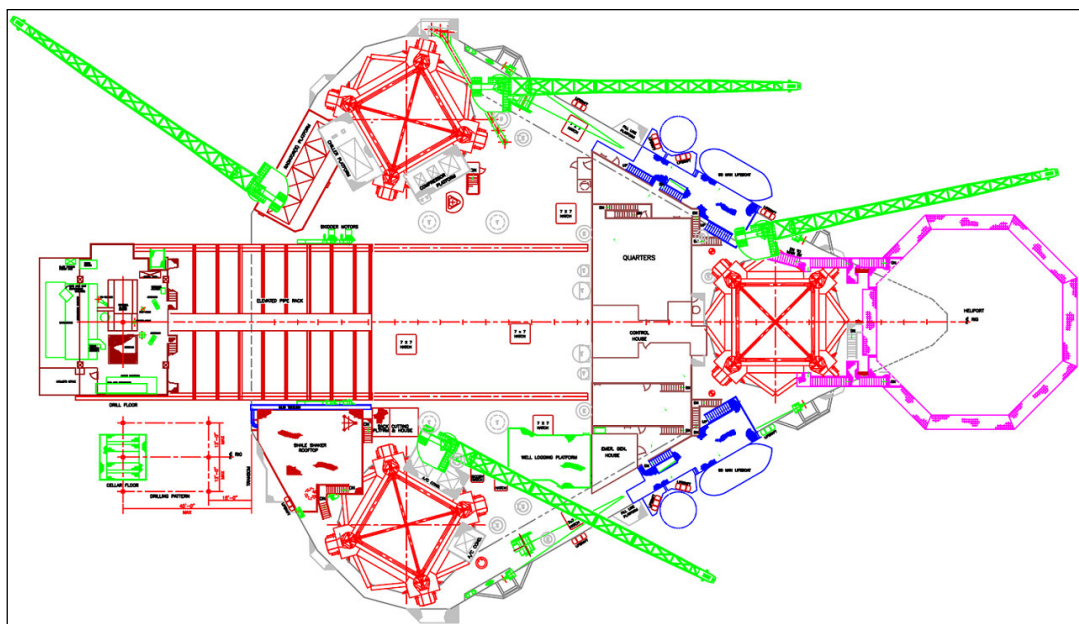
planimetria Impianto Jack-Up Drilling Unit (GSF Key Manhattan - Vista dall'alto del piano principale)
